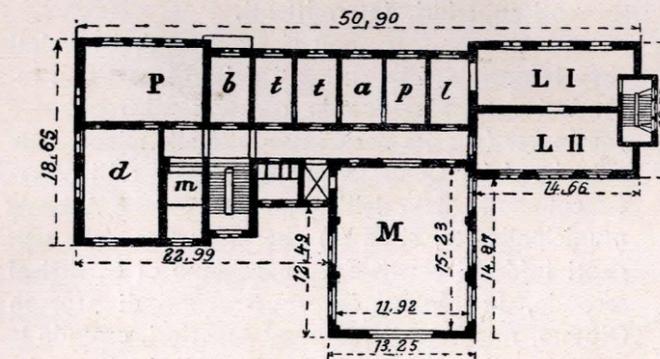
Istituto elettrotecnico (pianta piano terreno).
